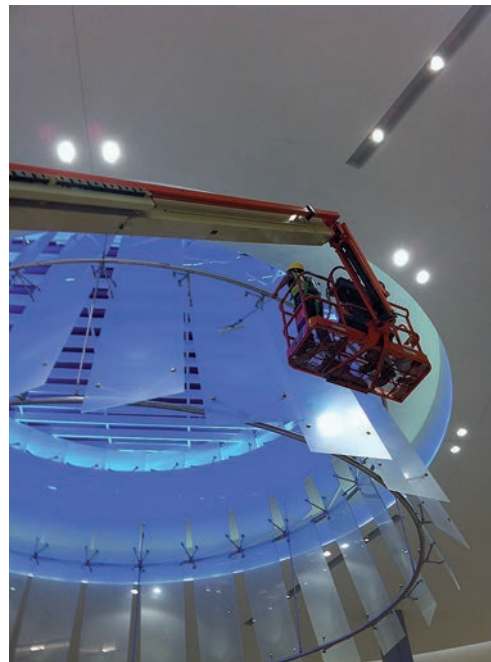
Beleuchteter Glas-Leuchter (Foto/Abb.: 1 Dlubal, 2 STUTZKI Engineering)
